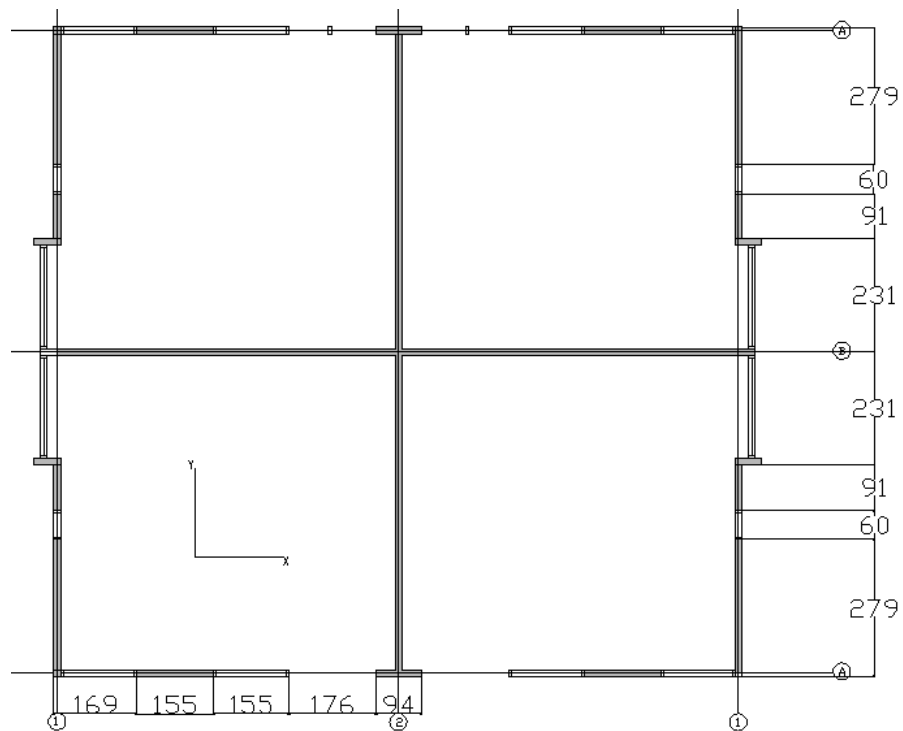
13. Planta tipo Edificio de 5 Pisos
